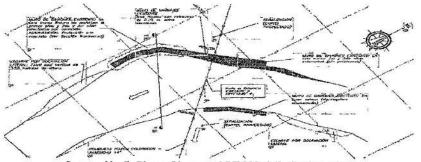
Planta Obras en el PK 299+378. CENIT, 2021.
